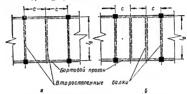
85. Примымание однопролетных балок к бортовым прогонам: « – при одной балке между колоннами; б – при двух балках между колоннами.
